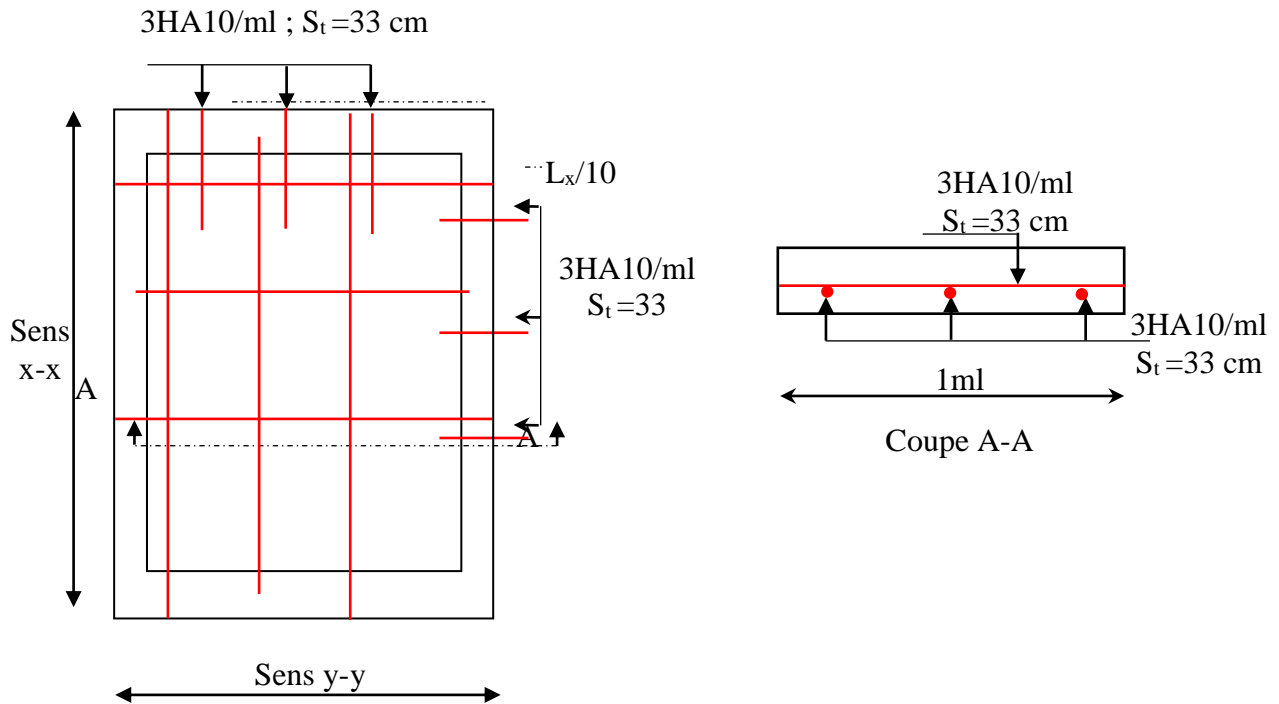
Schéma de ferrailage la dalle pleine au-dessous de l'ascenseur
